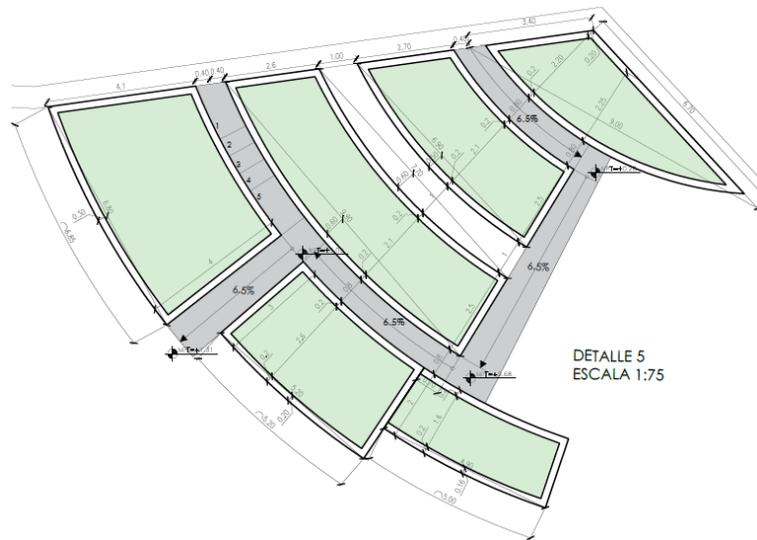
Planta Arquitectónica Huerta con cuadro de suelos
